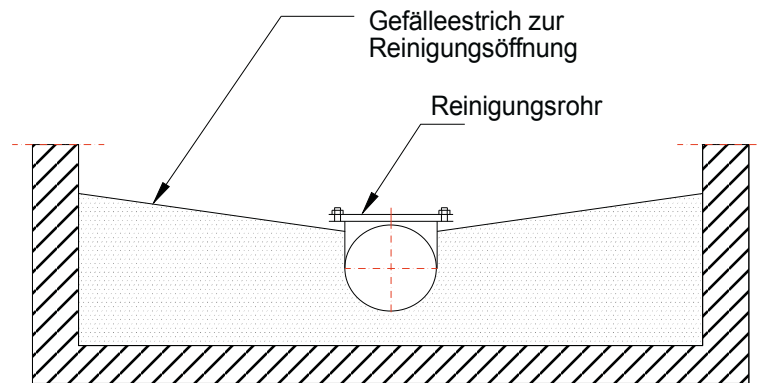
Schachtunterteil mit geschlossener Rohrdurchführung
